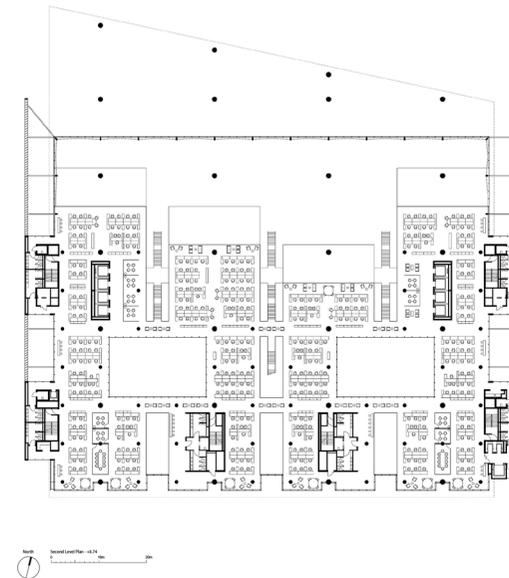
Planta baixa da Prefeitura de Buenos Aires. Sem escala.
